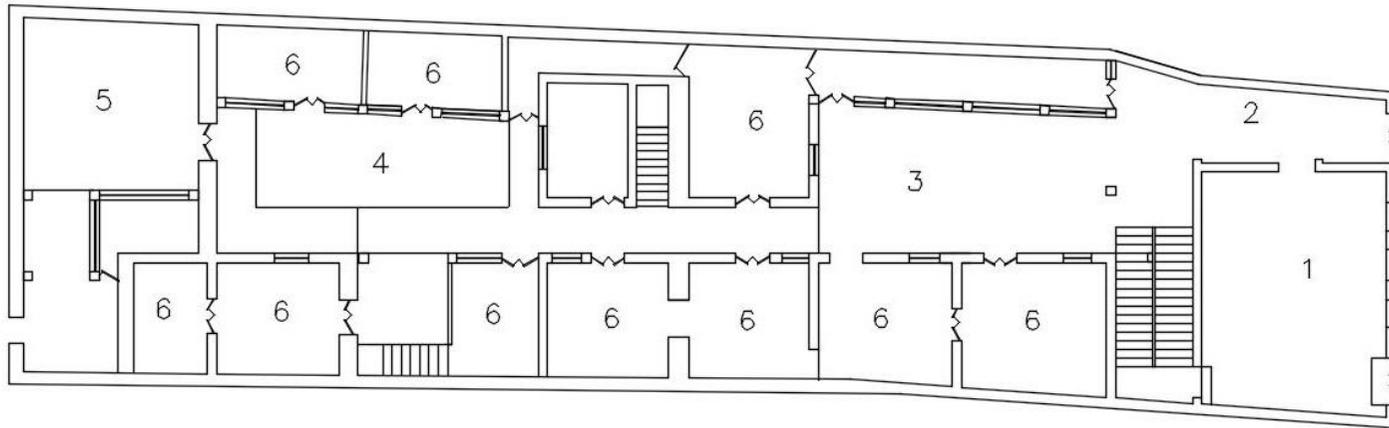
Planta de la Casa Cisneros - Naranjo.
